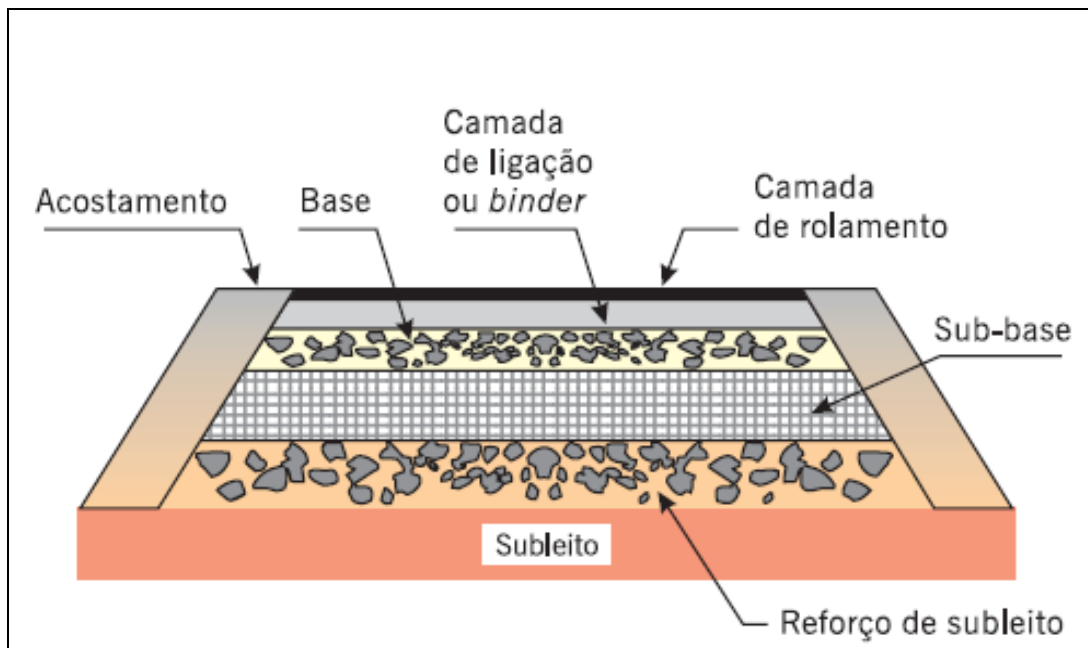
Pavimento asfáltico-corte transversal (BERNUCCI et al., 2006).
